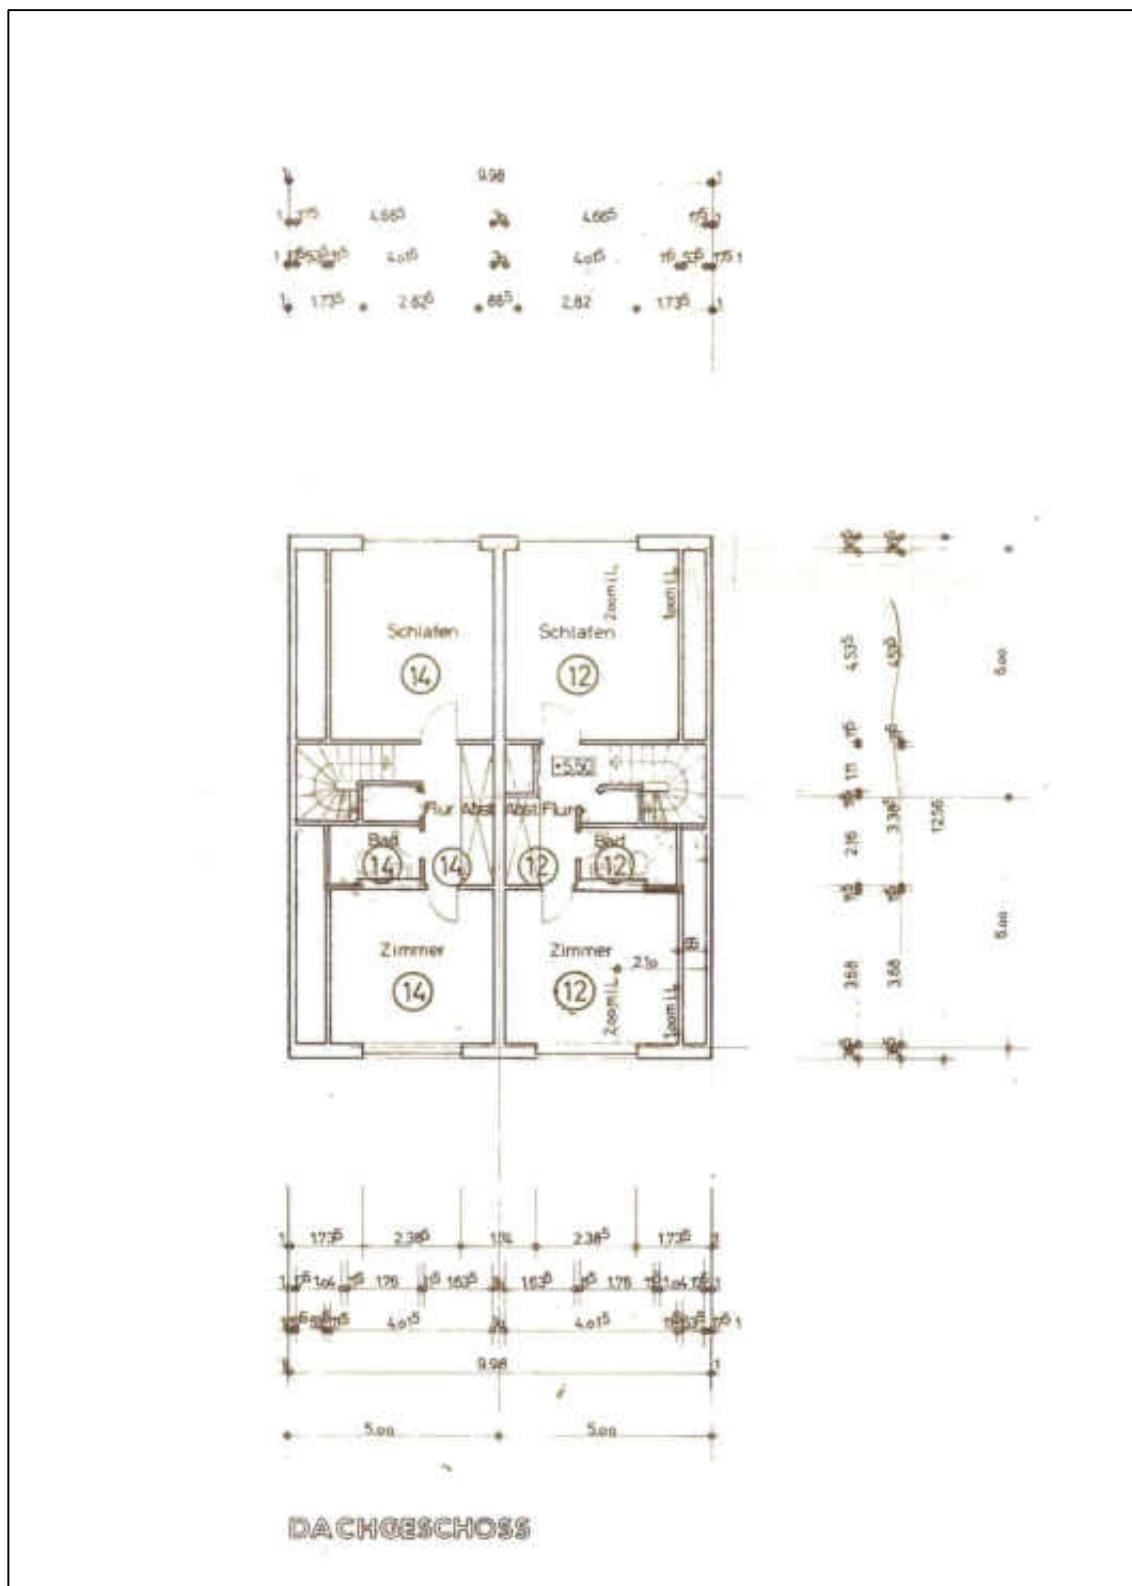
Grundriss vom Dachgeschoß Gebäudetyp B
